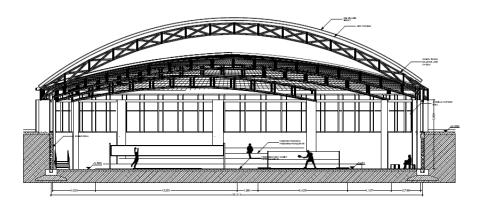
15. Potongan Bnagunan A1-A1 (R. Lapangan Basket dan Futsal)
